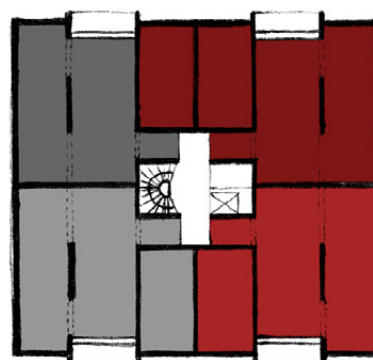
Clasificación de viviendas por planta antes de la renovación
